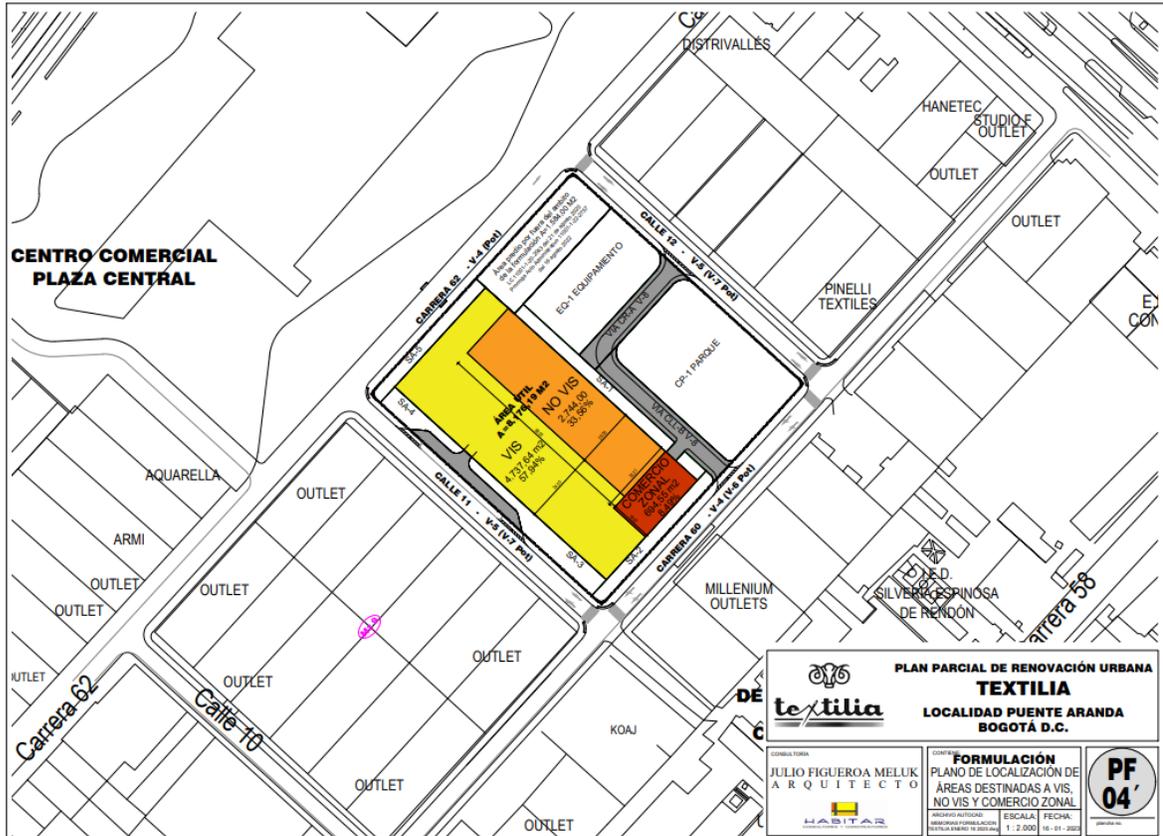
Plano PF-04' Áreas destinadas a VIS, no VIS y comercio zonal
